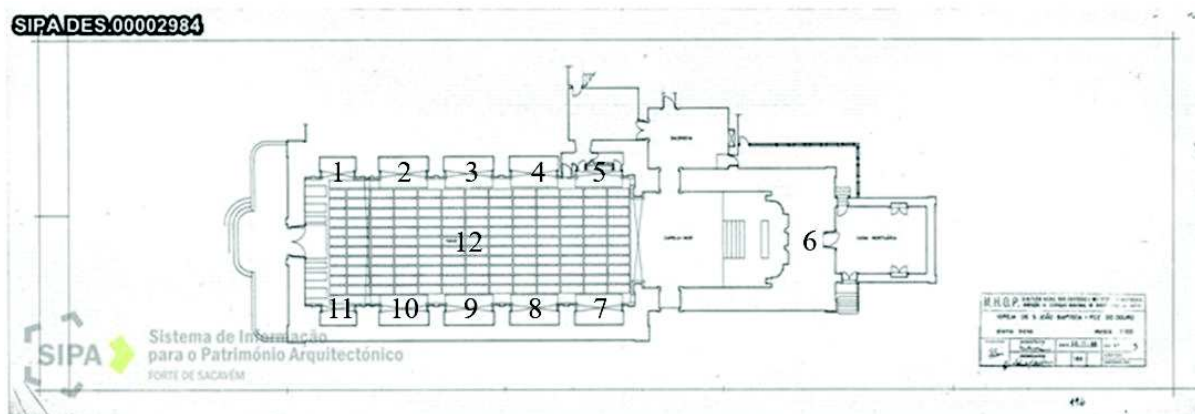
Planta do interior da Igreja Paroquial de São João Baptista da Foz do Douro.
